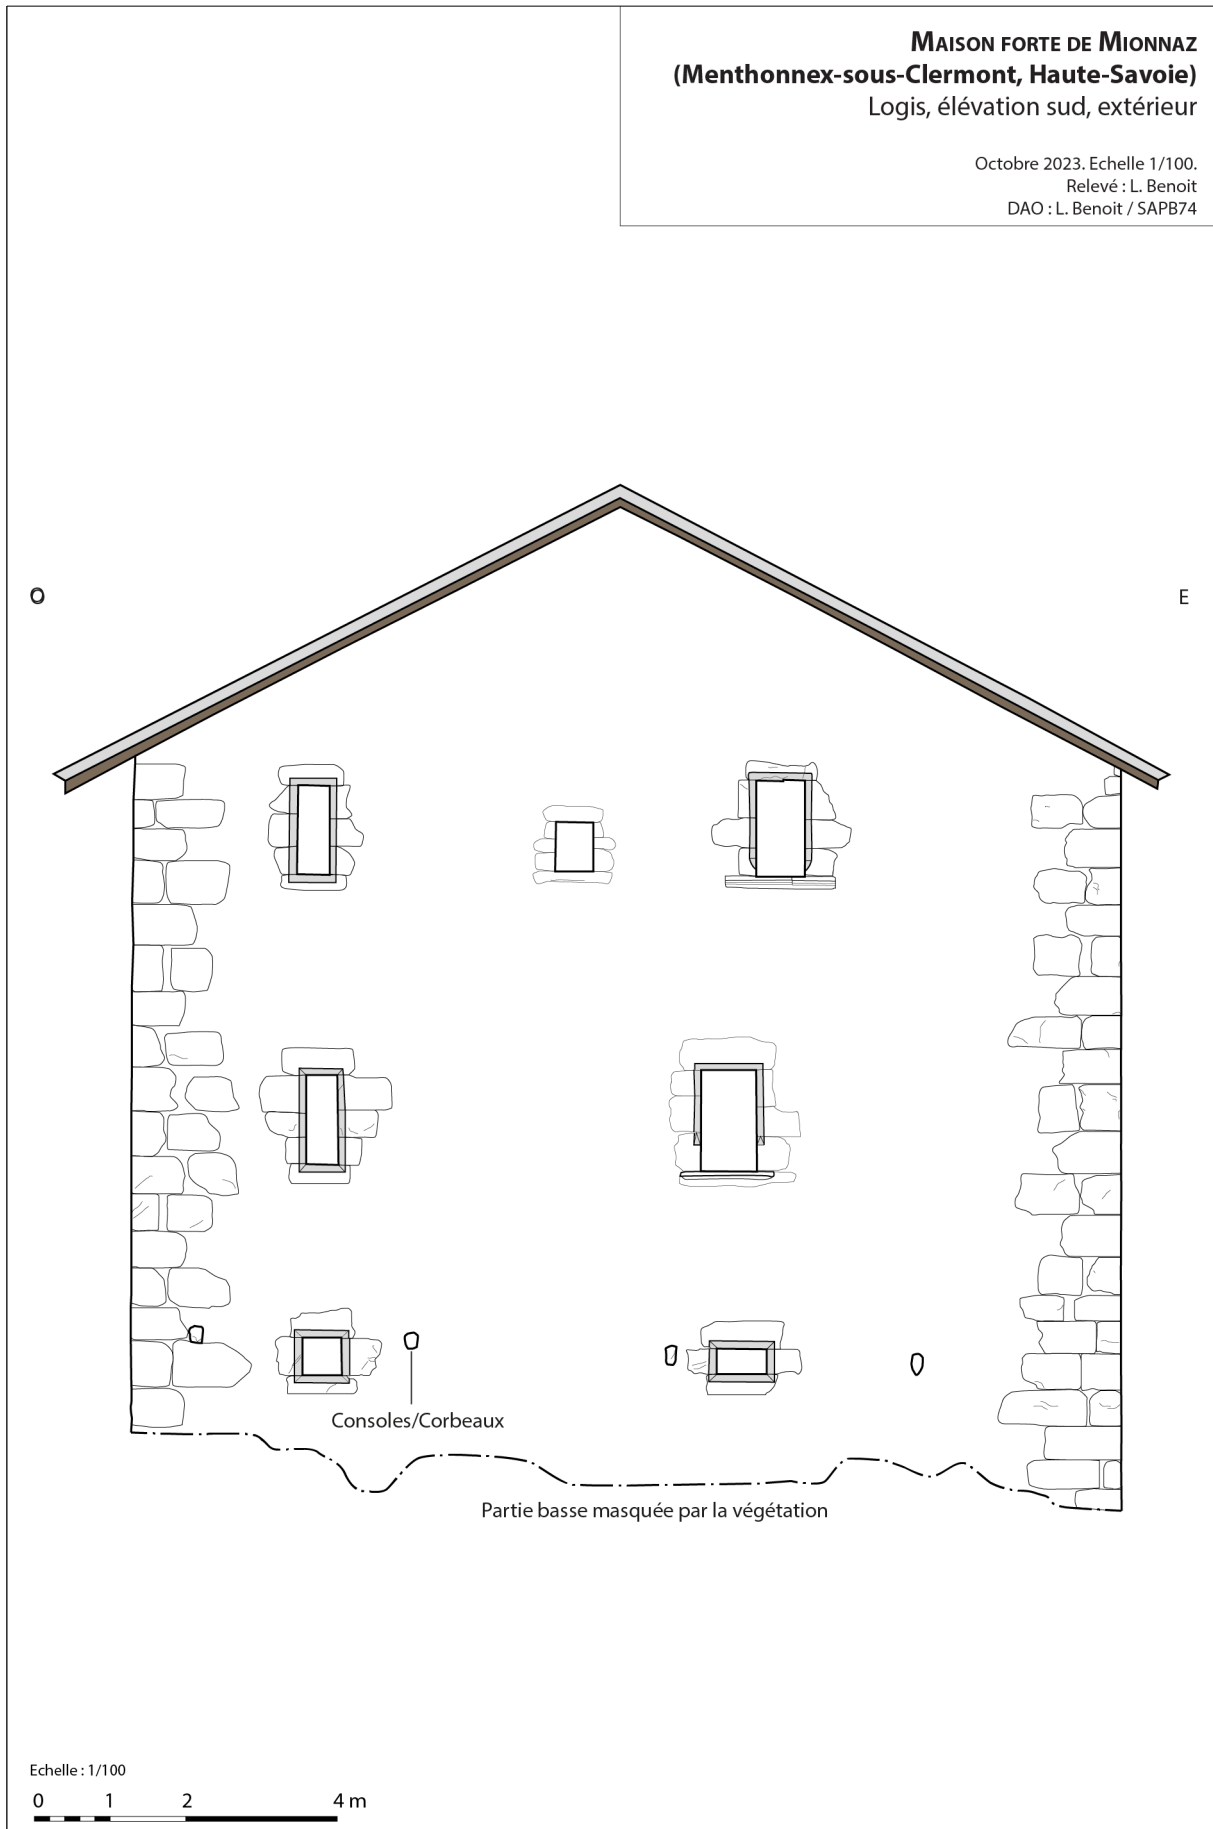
Mionnaz (74). Logis, façade sud. DAO : L. Benoit.
